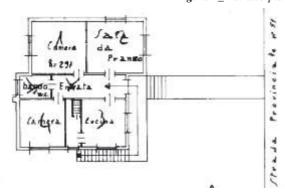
Estratto planimetria catastale, relativa al piano primo
